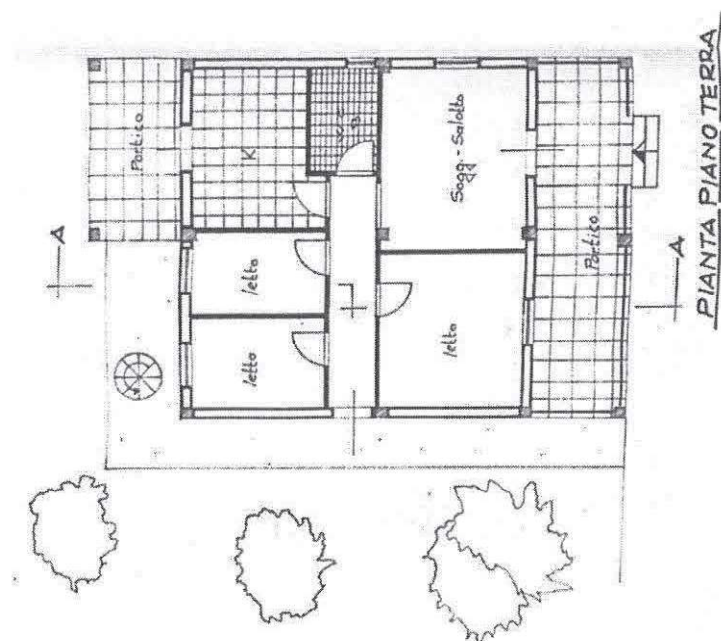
Planimetria di impianto allegata all'istanza di condono prot. 6781 del 21/03/1986
